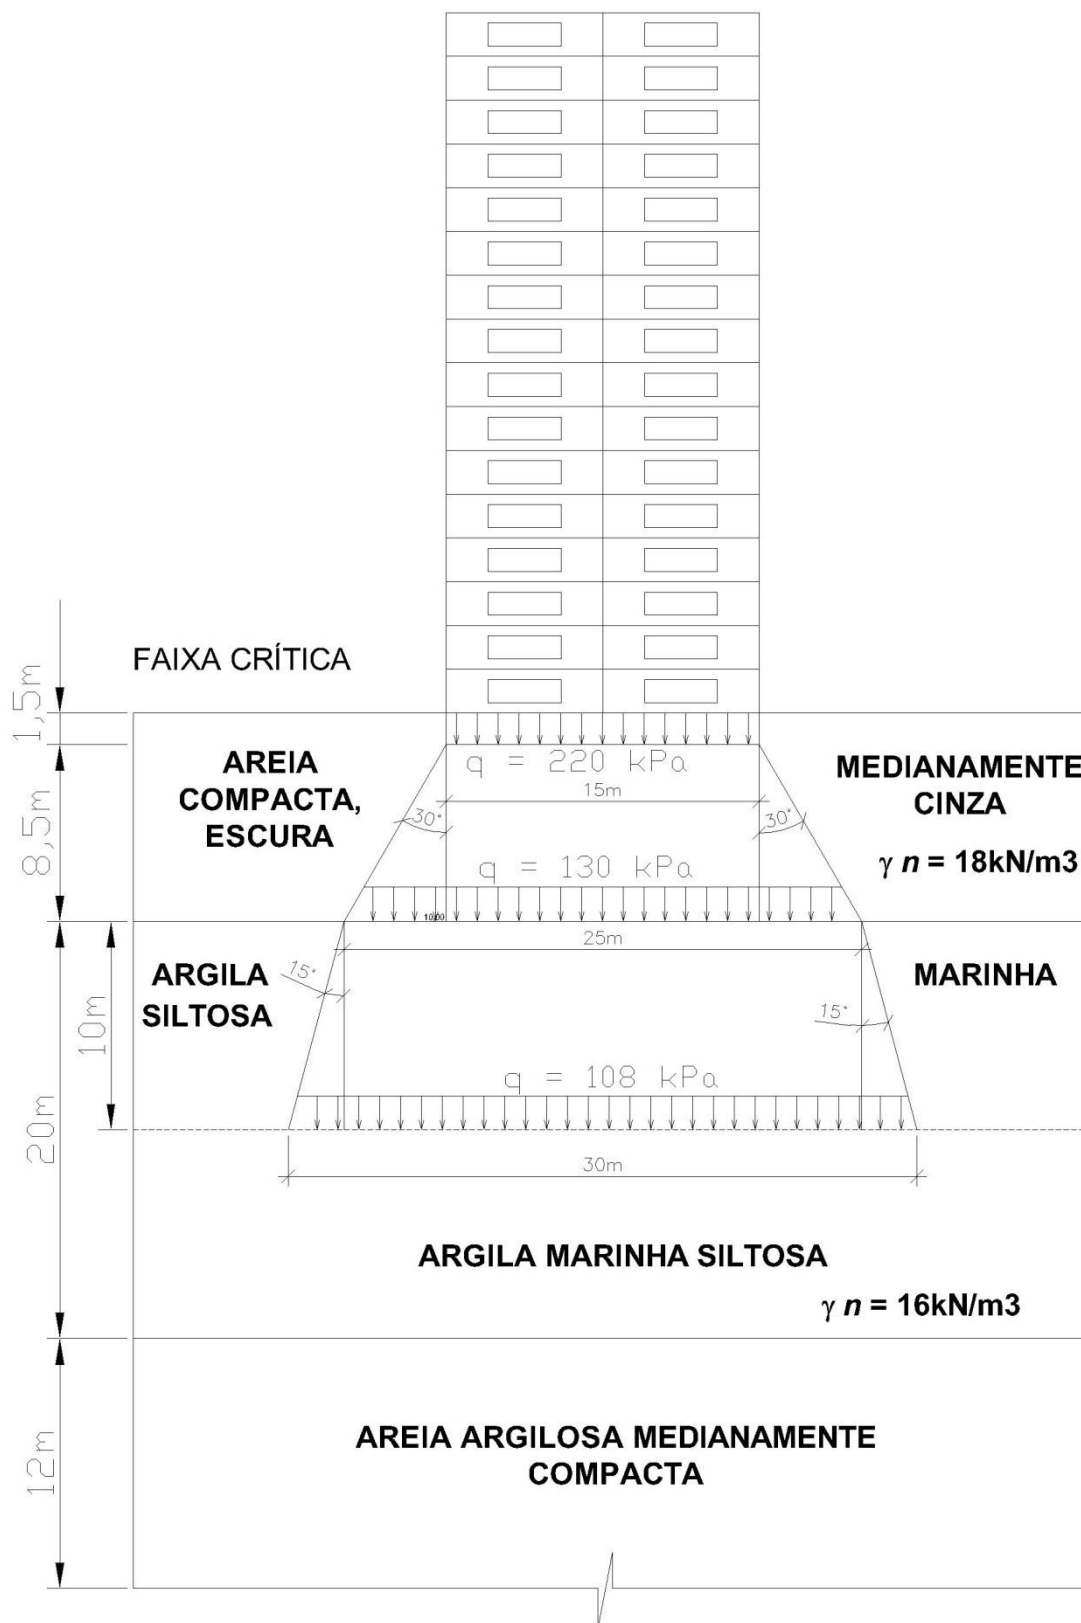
Esquema de dissipação de cargas para o perfil adotado da “Faixa Crítica” edifício “A”, com 16 pavimentos
